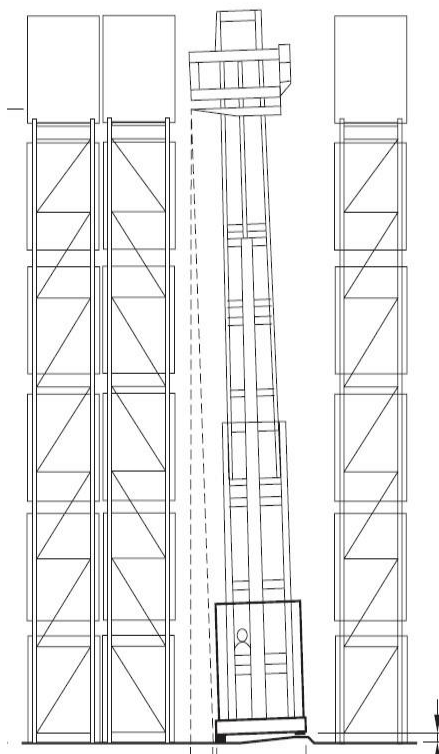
Effetti della planarità della pavimentazione su scaffali APR (porta pallet) Fonte
